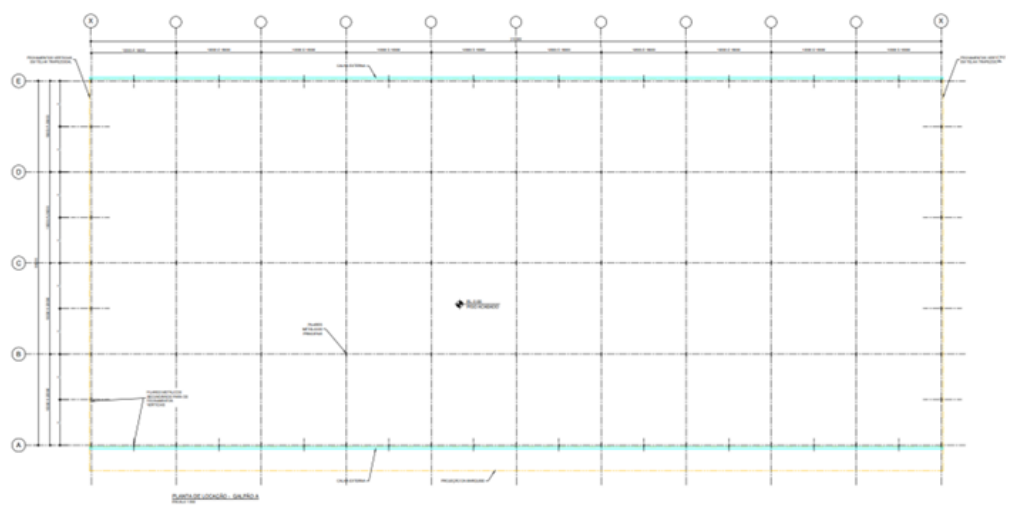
PLANTA DE LOCAÇÃO DO GALPÃO
